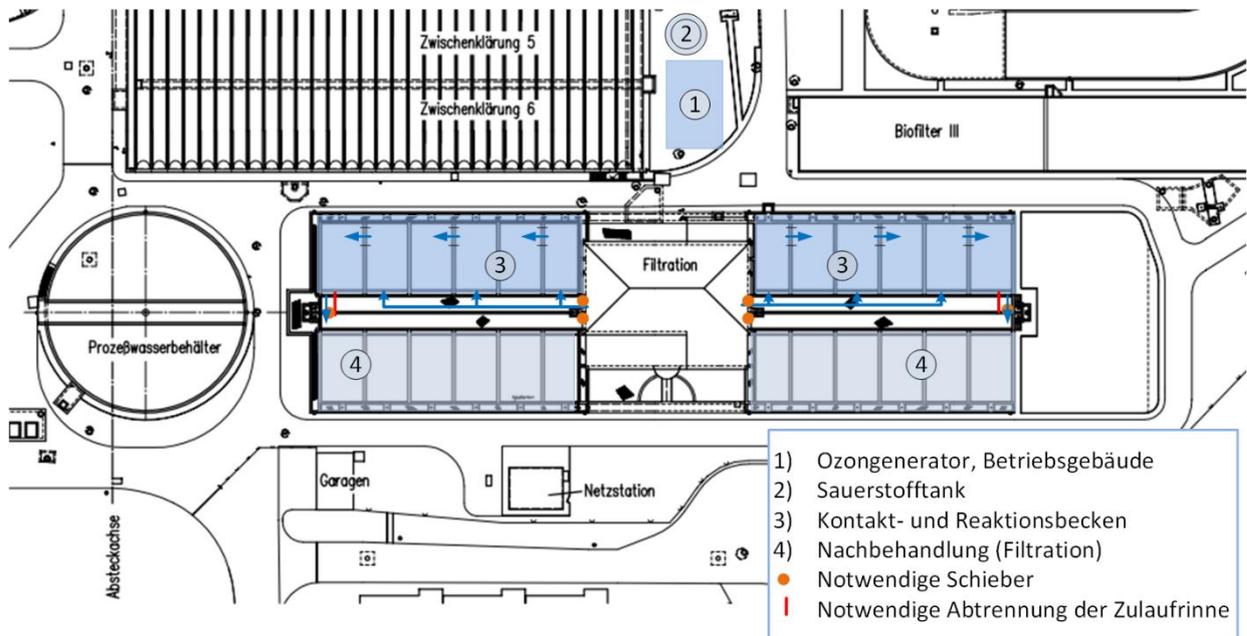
Lageplan der Variante 1 auf dem Klärwerk Krefeld
